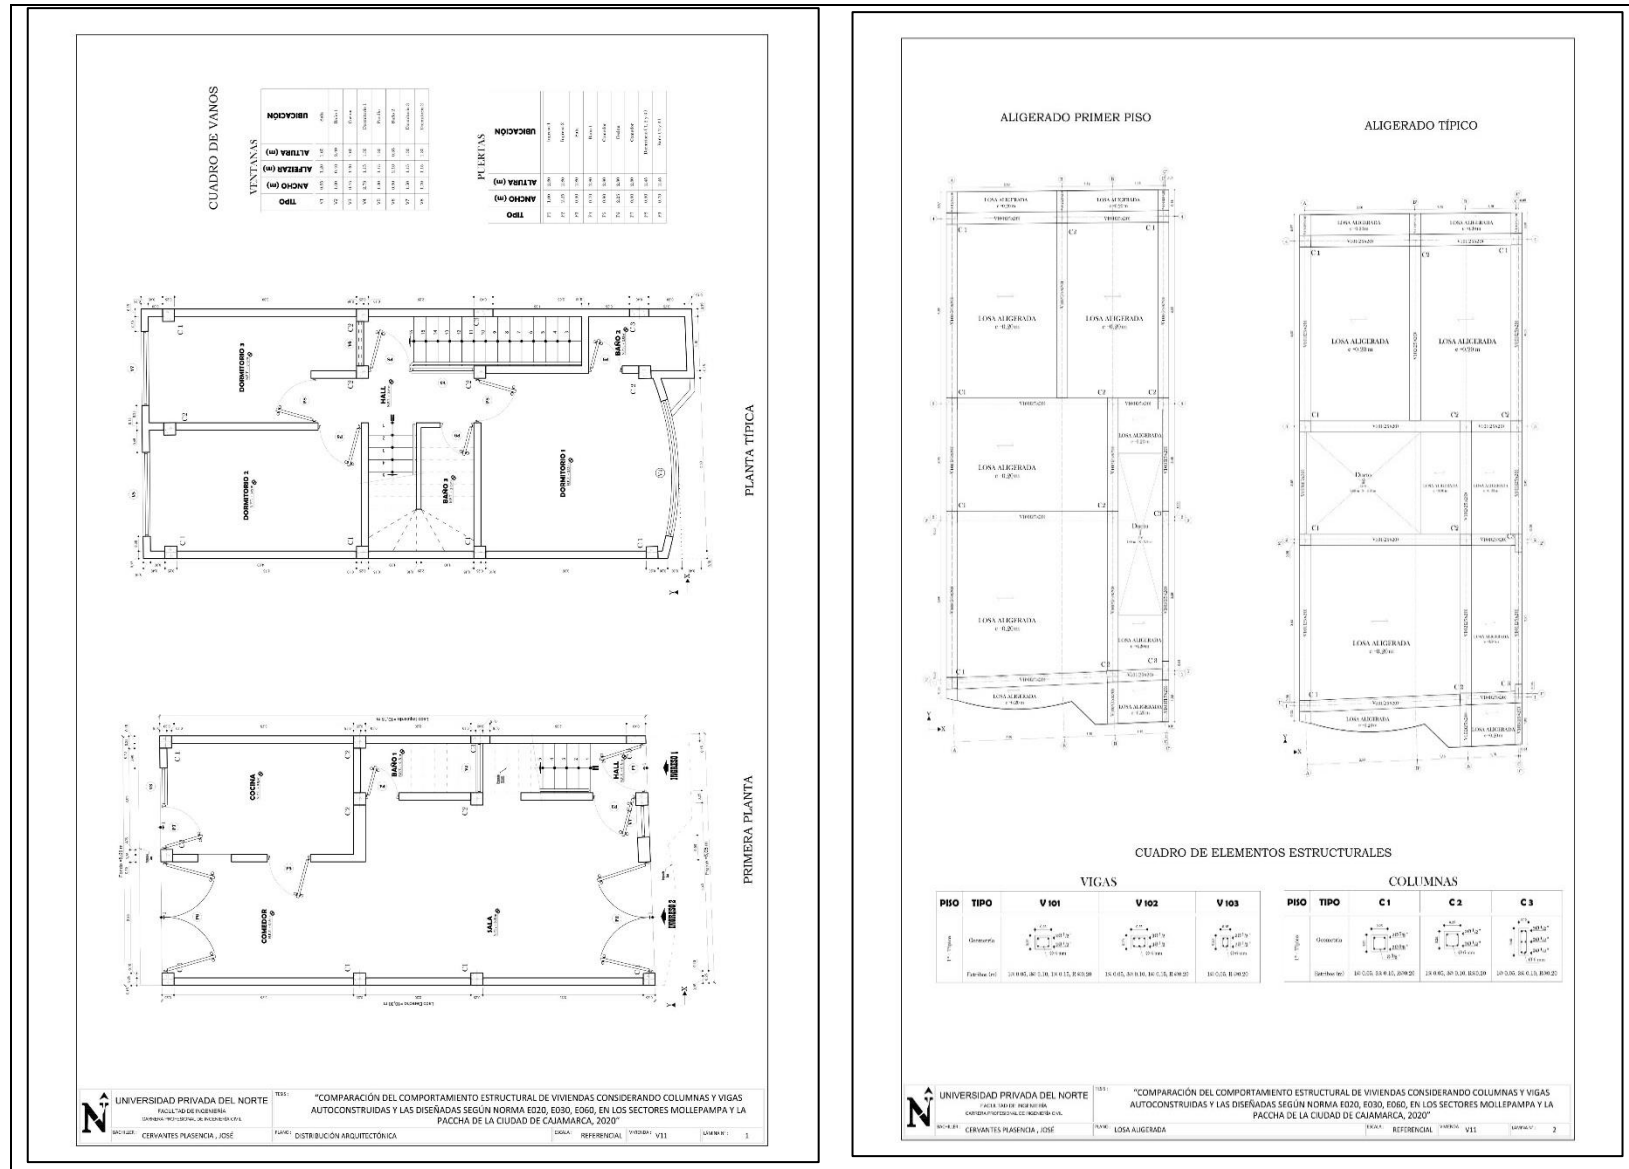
Planos de arquitectura y losa aligerada vivienda 11
